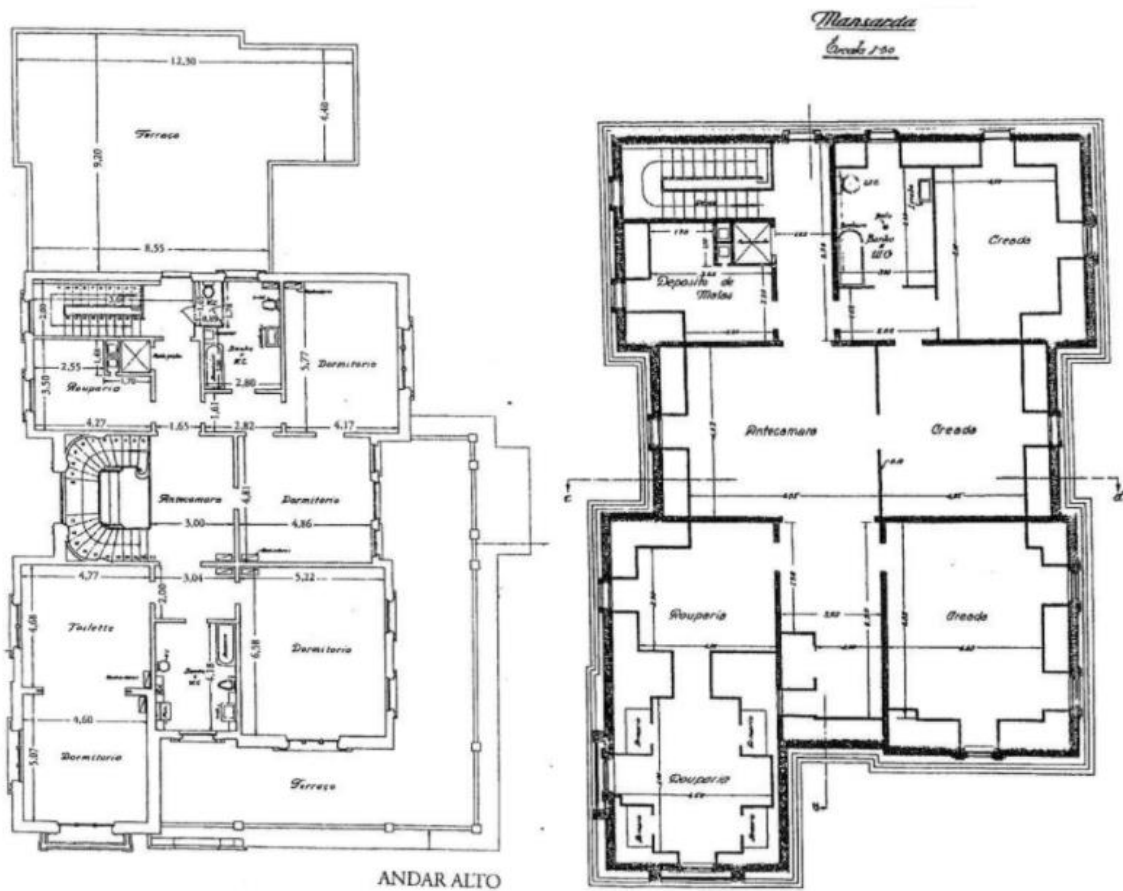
Planta do pavimento superior (Andar Alto). Data: 1929.
